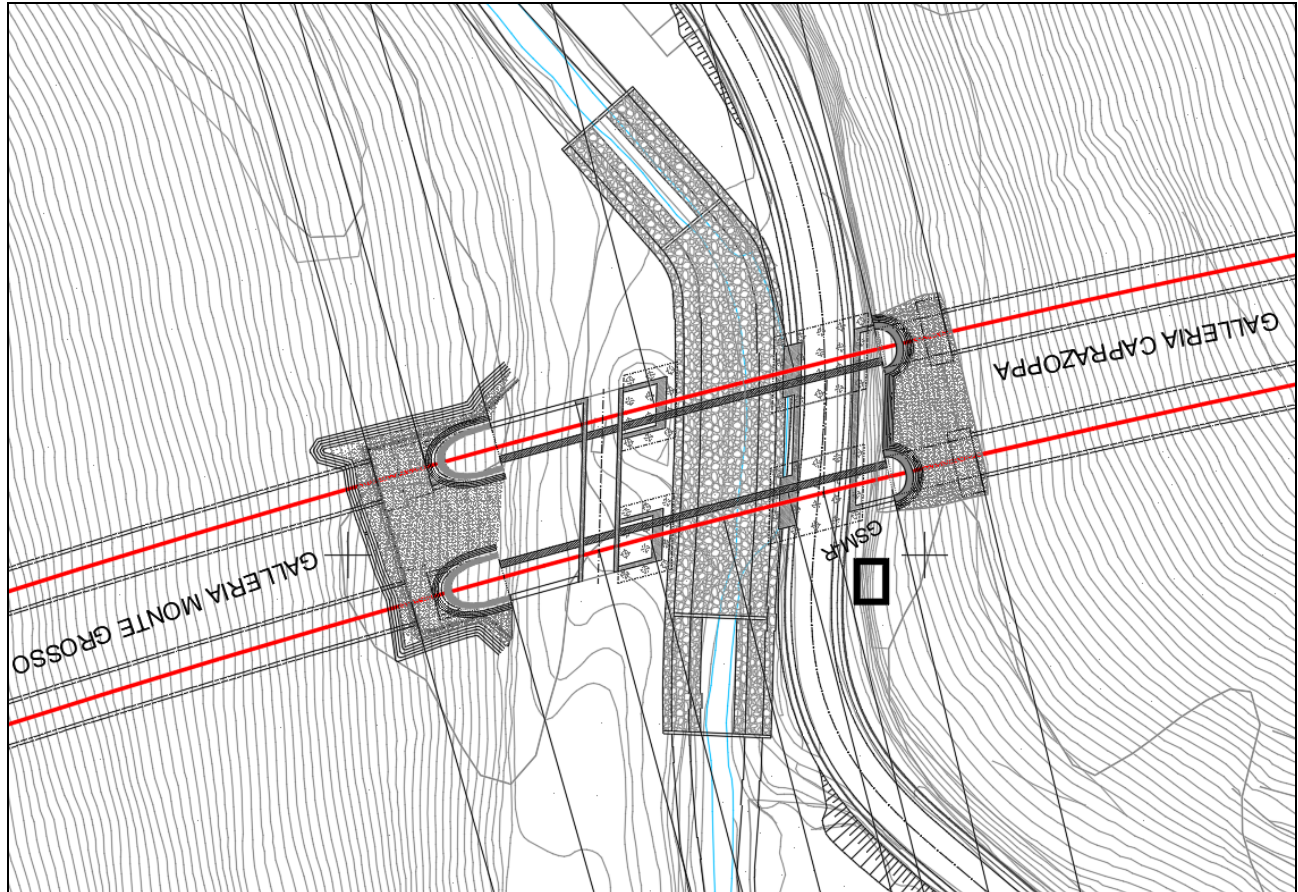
Torrente Bottassano, VI01: stralcio della planimetria di progetto
